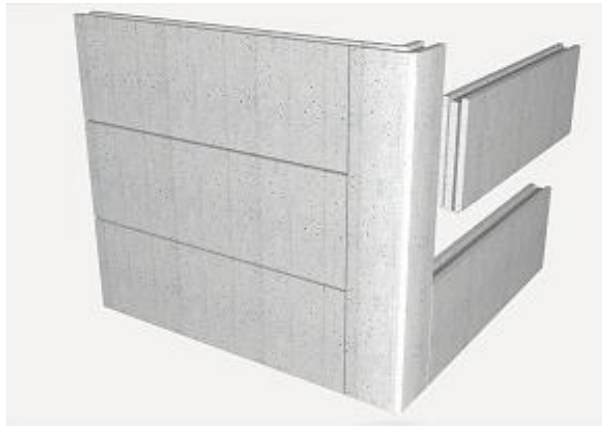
Panel de hormigón prefabricado
